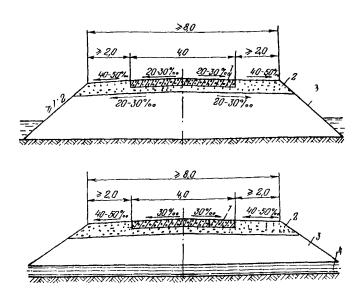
Поперечные профили однополосных дорог со сборным покрытием из железобетонных плит при строительстве тру - бопроводов диаметром более 1020 мм:
